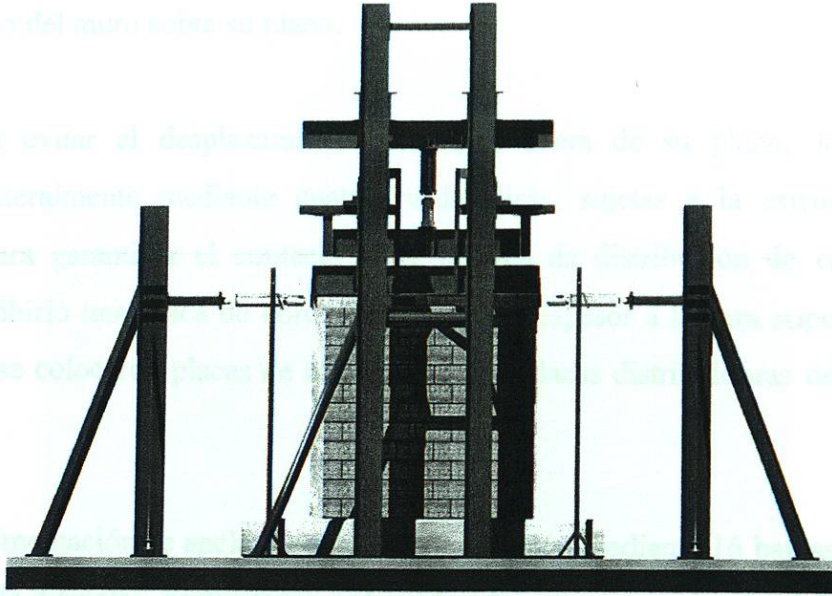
Dispositivo de aplicación de carga. Elevación
